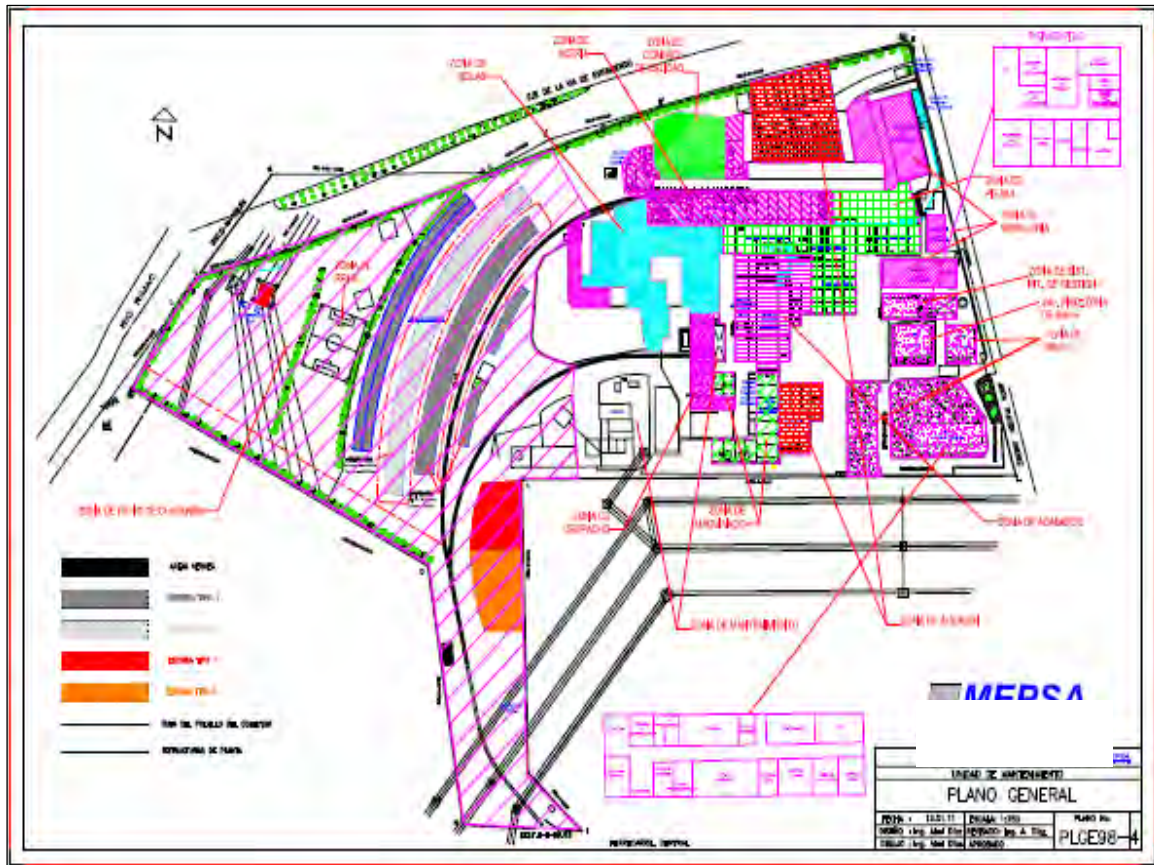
Layout de la planta de Fundición S.A. en El Agustino.
